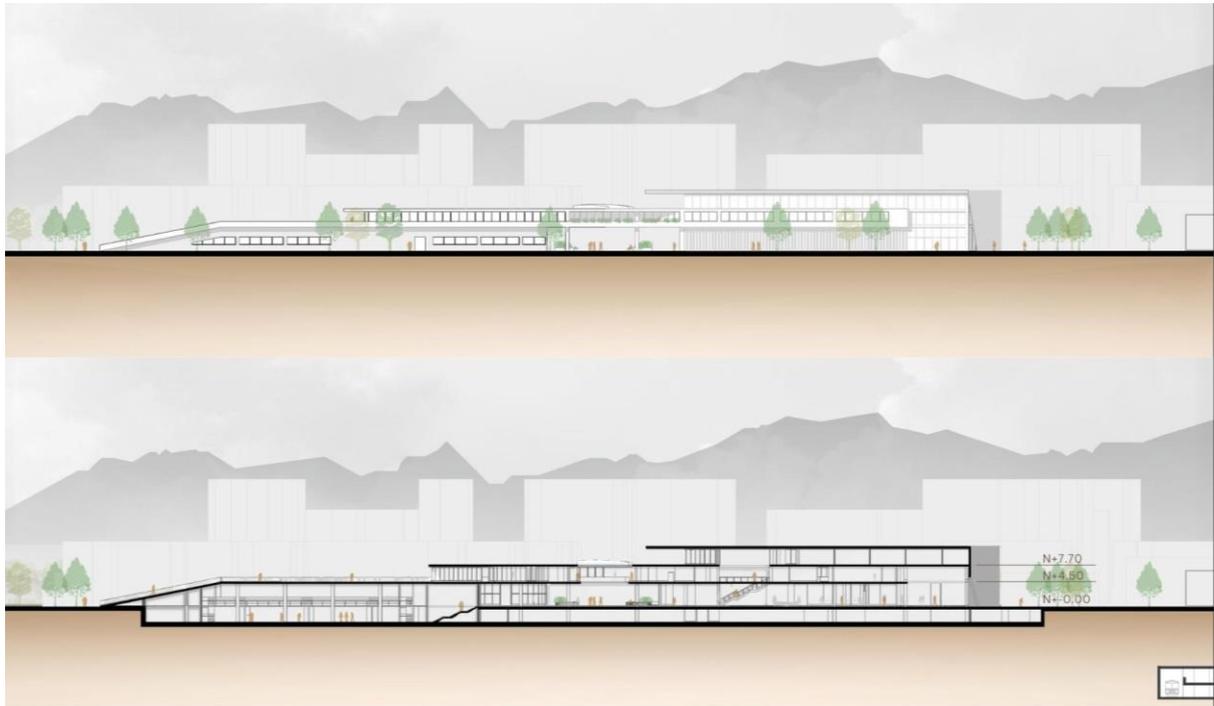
Fachada y Corte Centro Deportivo. Elaboración propia
